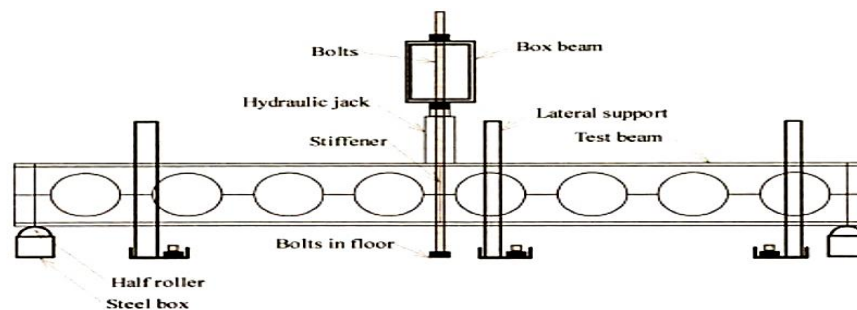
Dispositif d'essai de flexion trois points [4]
